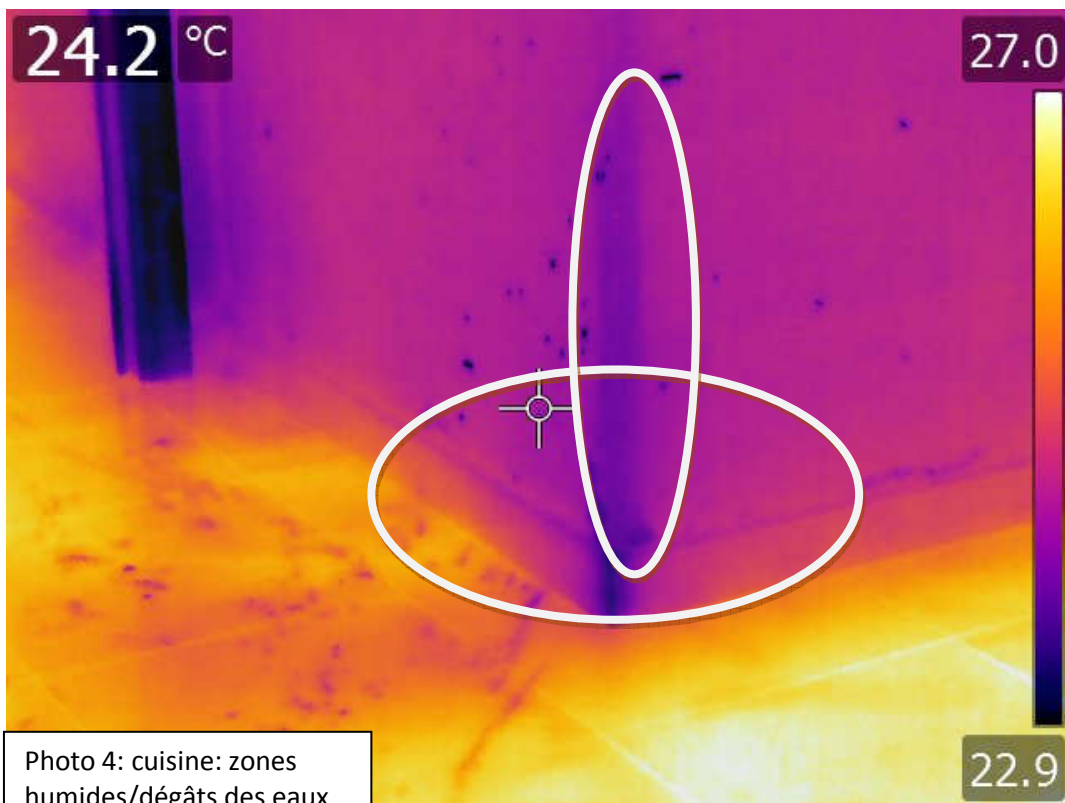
cuisine: zones humides/dégâts des eaux sur les murs mitoyens avec le hall
